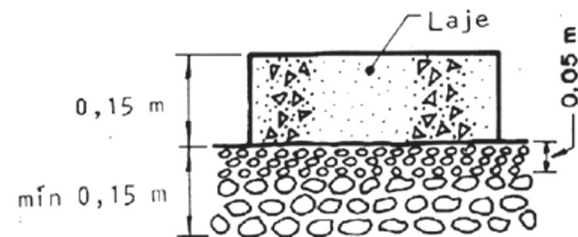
Laje sobre lastro de brita (fundação)
